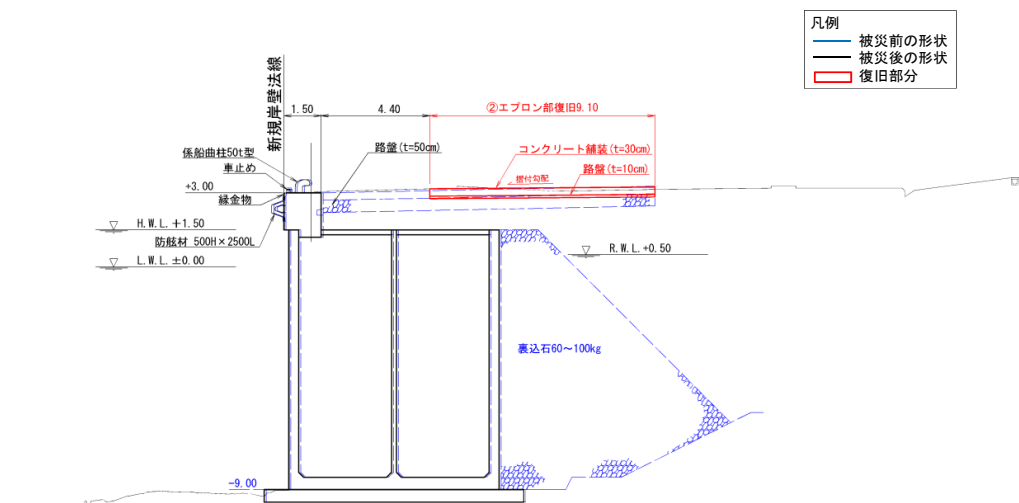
No.5 日立港区\_第2埠頭地区 2-B岸壁（-9m）の断面図（復旧後）
